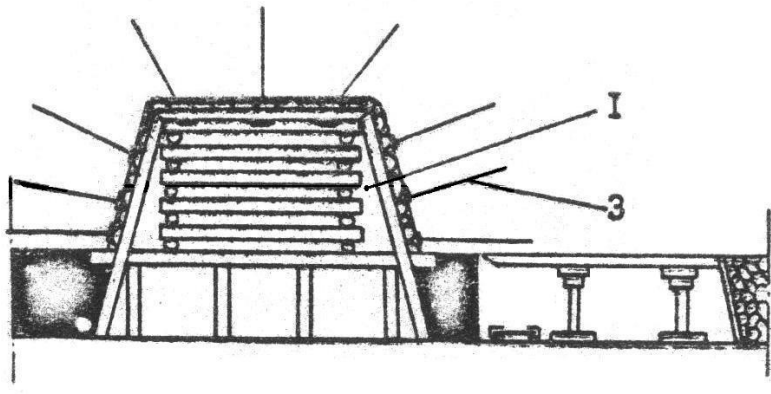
Схема перехода лавой выработки, пройденной с подрывкой пород кровли:
